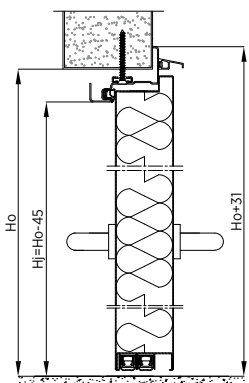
Montage an die Stahlkonstruktion einer einflügeligen Tür mit Eckzarge mit thermischer Trennung - Vertikalschnitt
